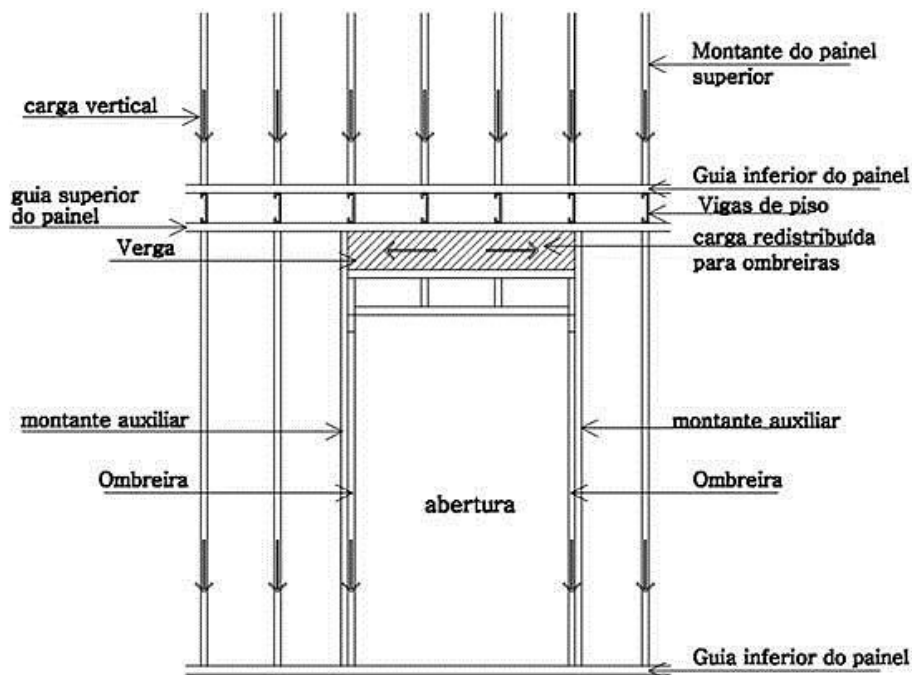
Painel estrutural com vergas e reforços estruturais para aberturas
